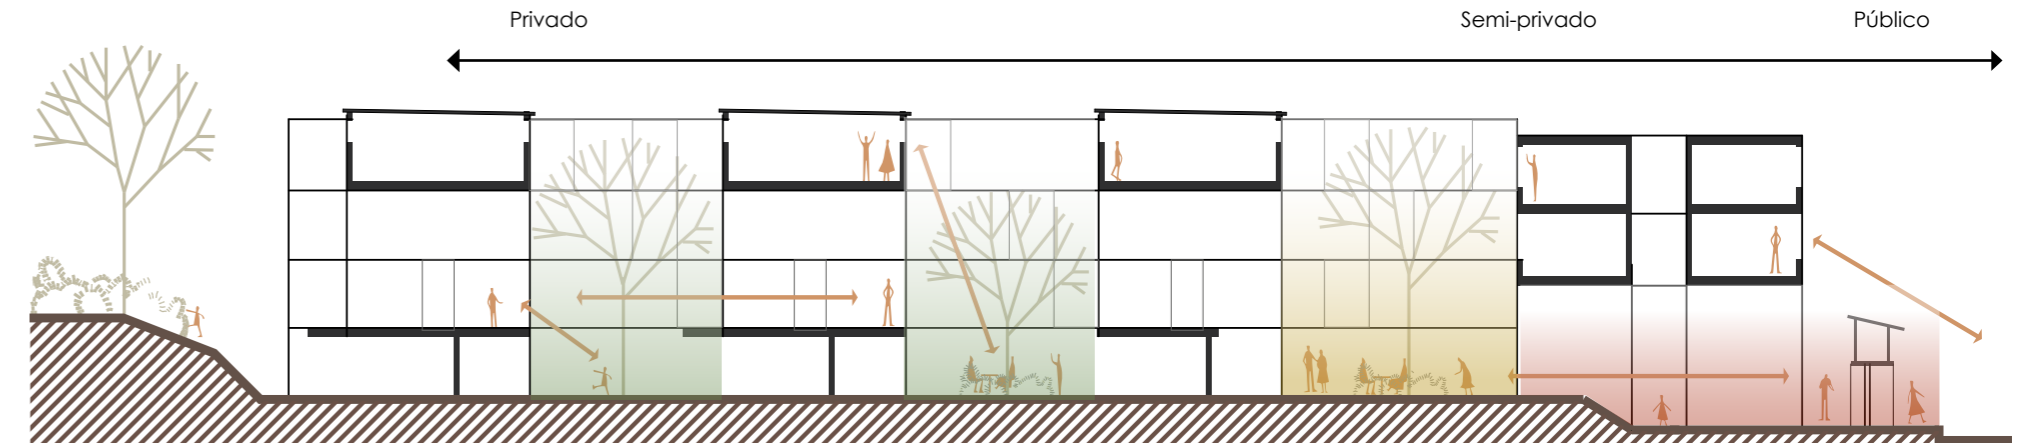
Sección longitudinal, gradiente de espacio público a privado. Autoría propia.
